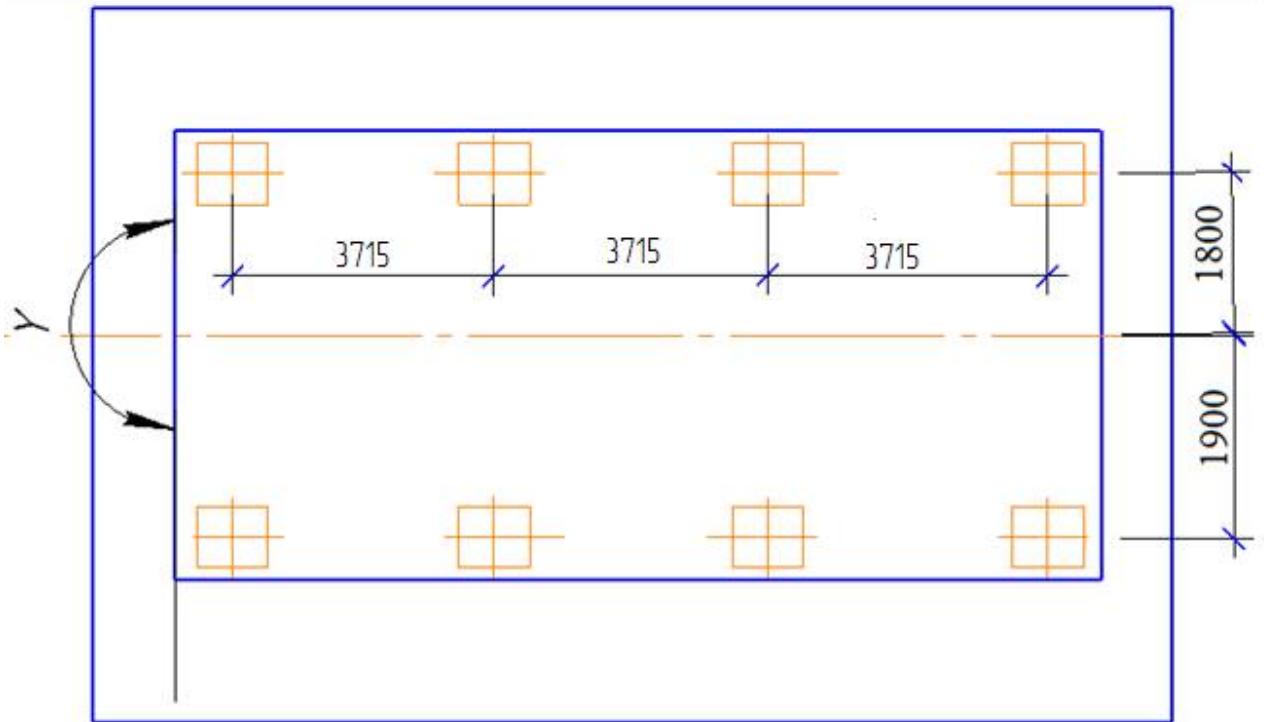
Схема кріплення рольганга до фундаменту
